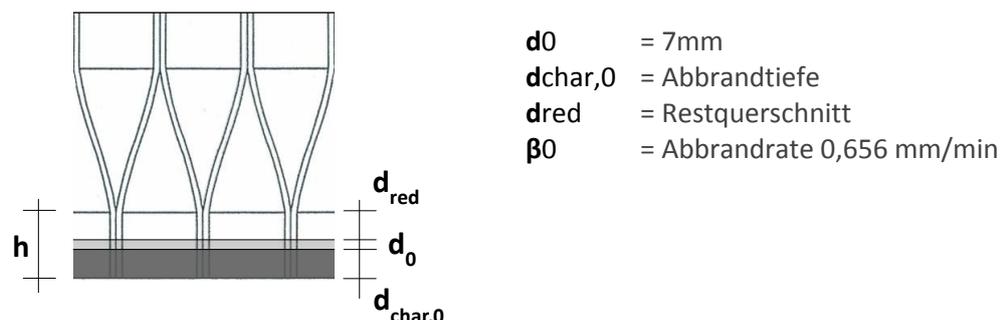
Relevante Querschnittabmessungen zur Abbrandberechnung gemäß EN 1995-1-2.
